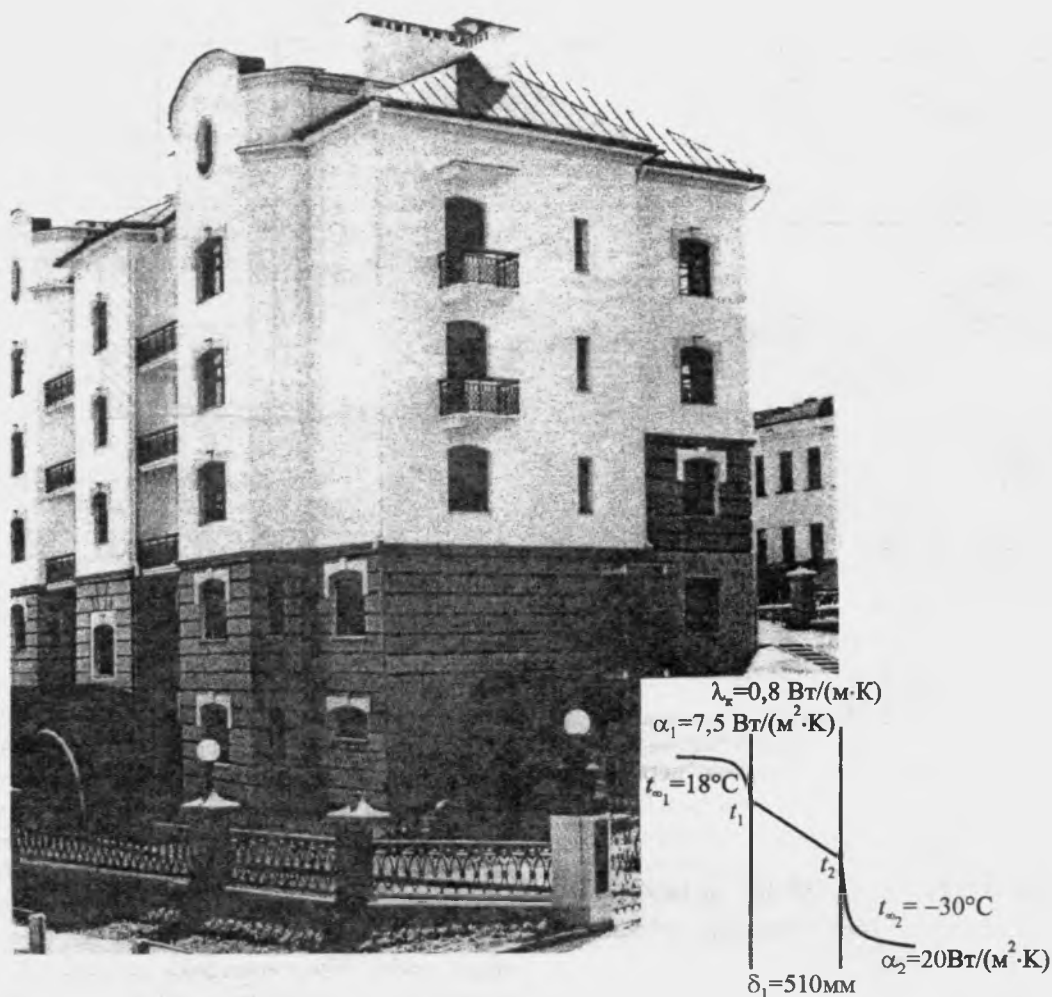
(к примеру 7.6). К определению тепловых потерь с 1 м² стеновой конструкции жилого кирпичного здания
